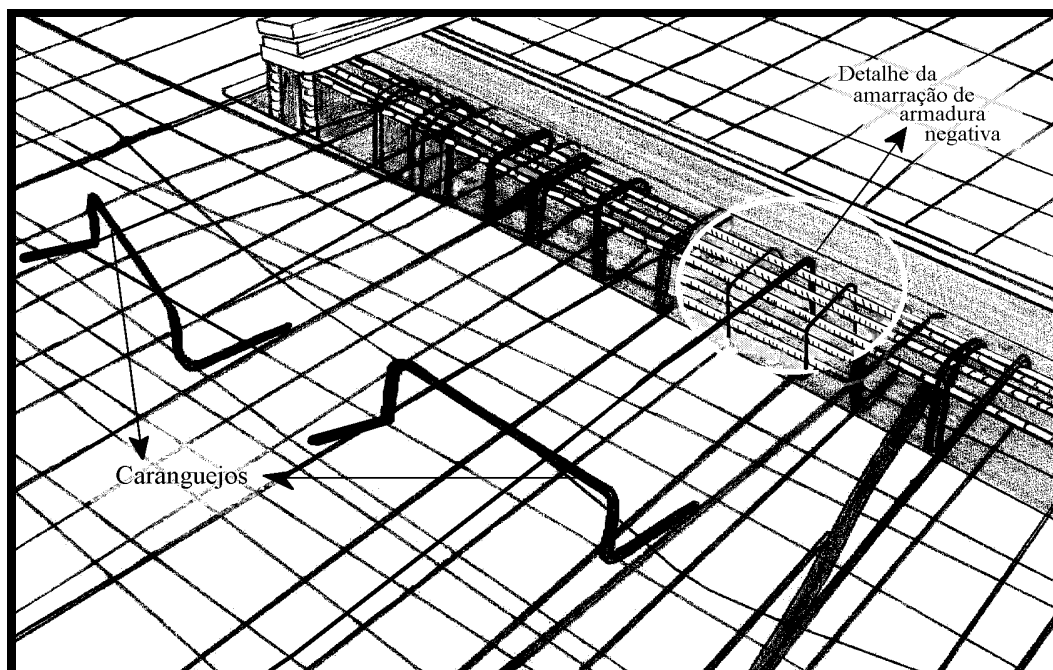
FIGURA G - Detalhe da amarração das armaduras negativas e colocação de “caranguejos”
